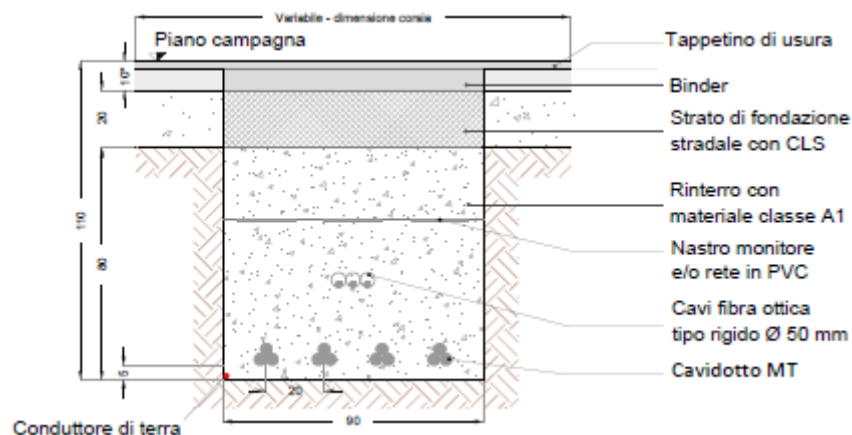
Sezione tipo cavidotto su strade asfaltate Cavidotto 30 kV
